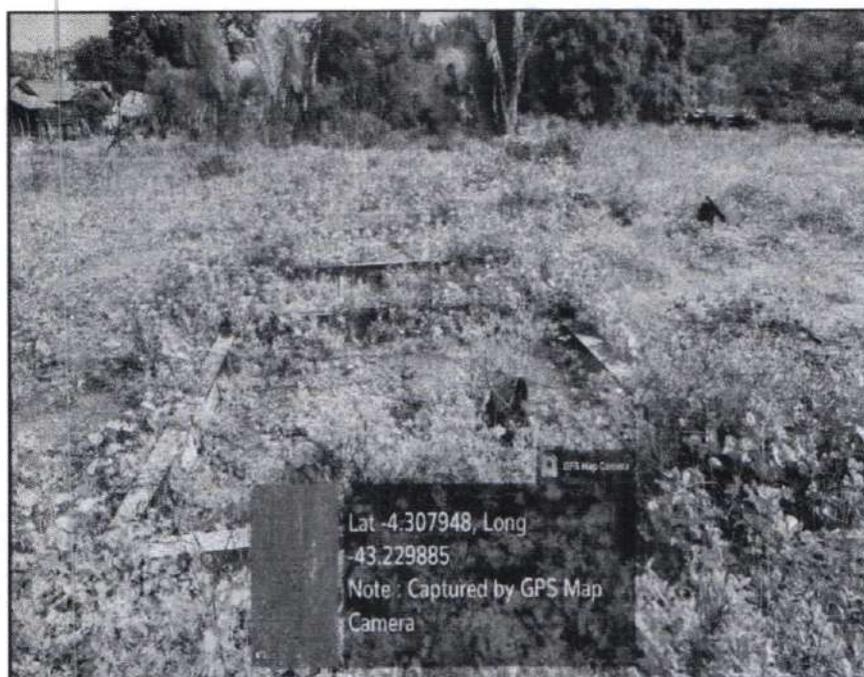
Vigas baldrame encontram-se expostas, sem o aterro previsto executado e sem o recebimento de impermeabilização. Fonte: elaboração própria
